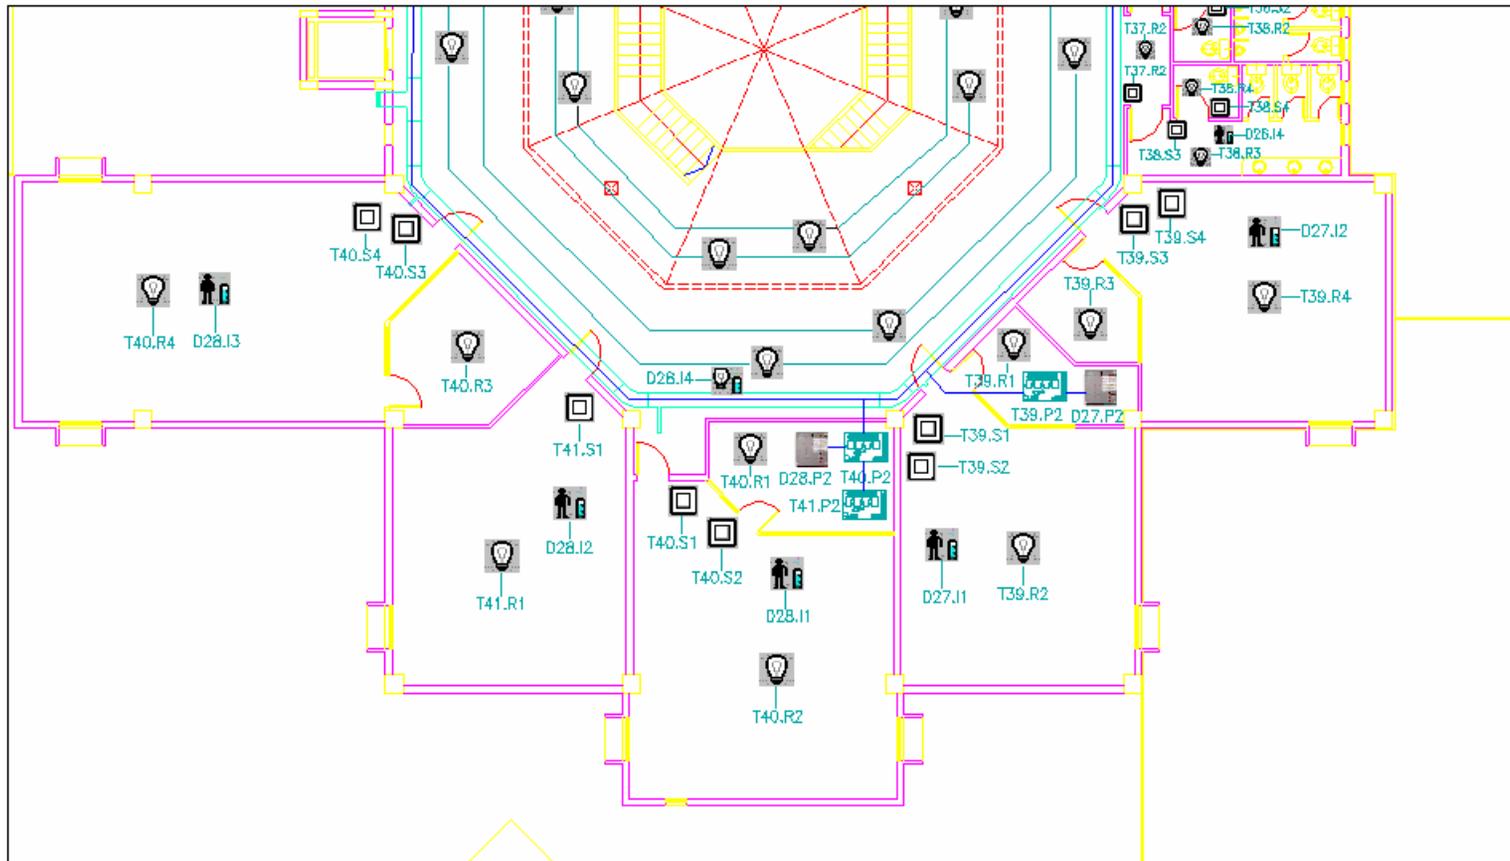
PLANO ILUMINACION SEGUNDO PISO SECCION 1
